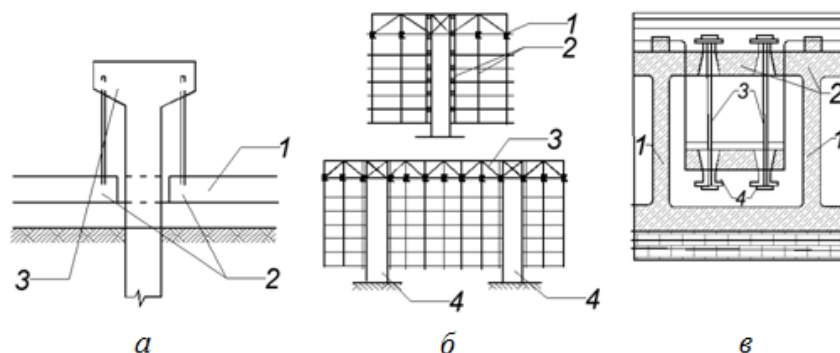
Примеры подвесных конструкций: а – подвеска ростверка к консолям свай; б – подвесное здание; в – фундамент-амортизатор Зеленькова Ф. Д.
